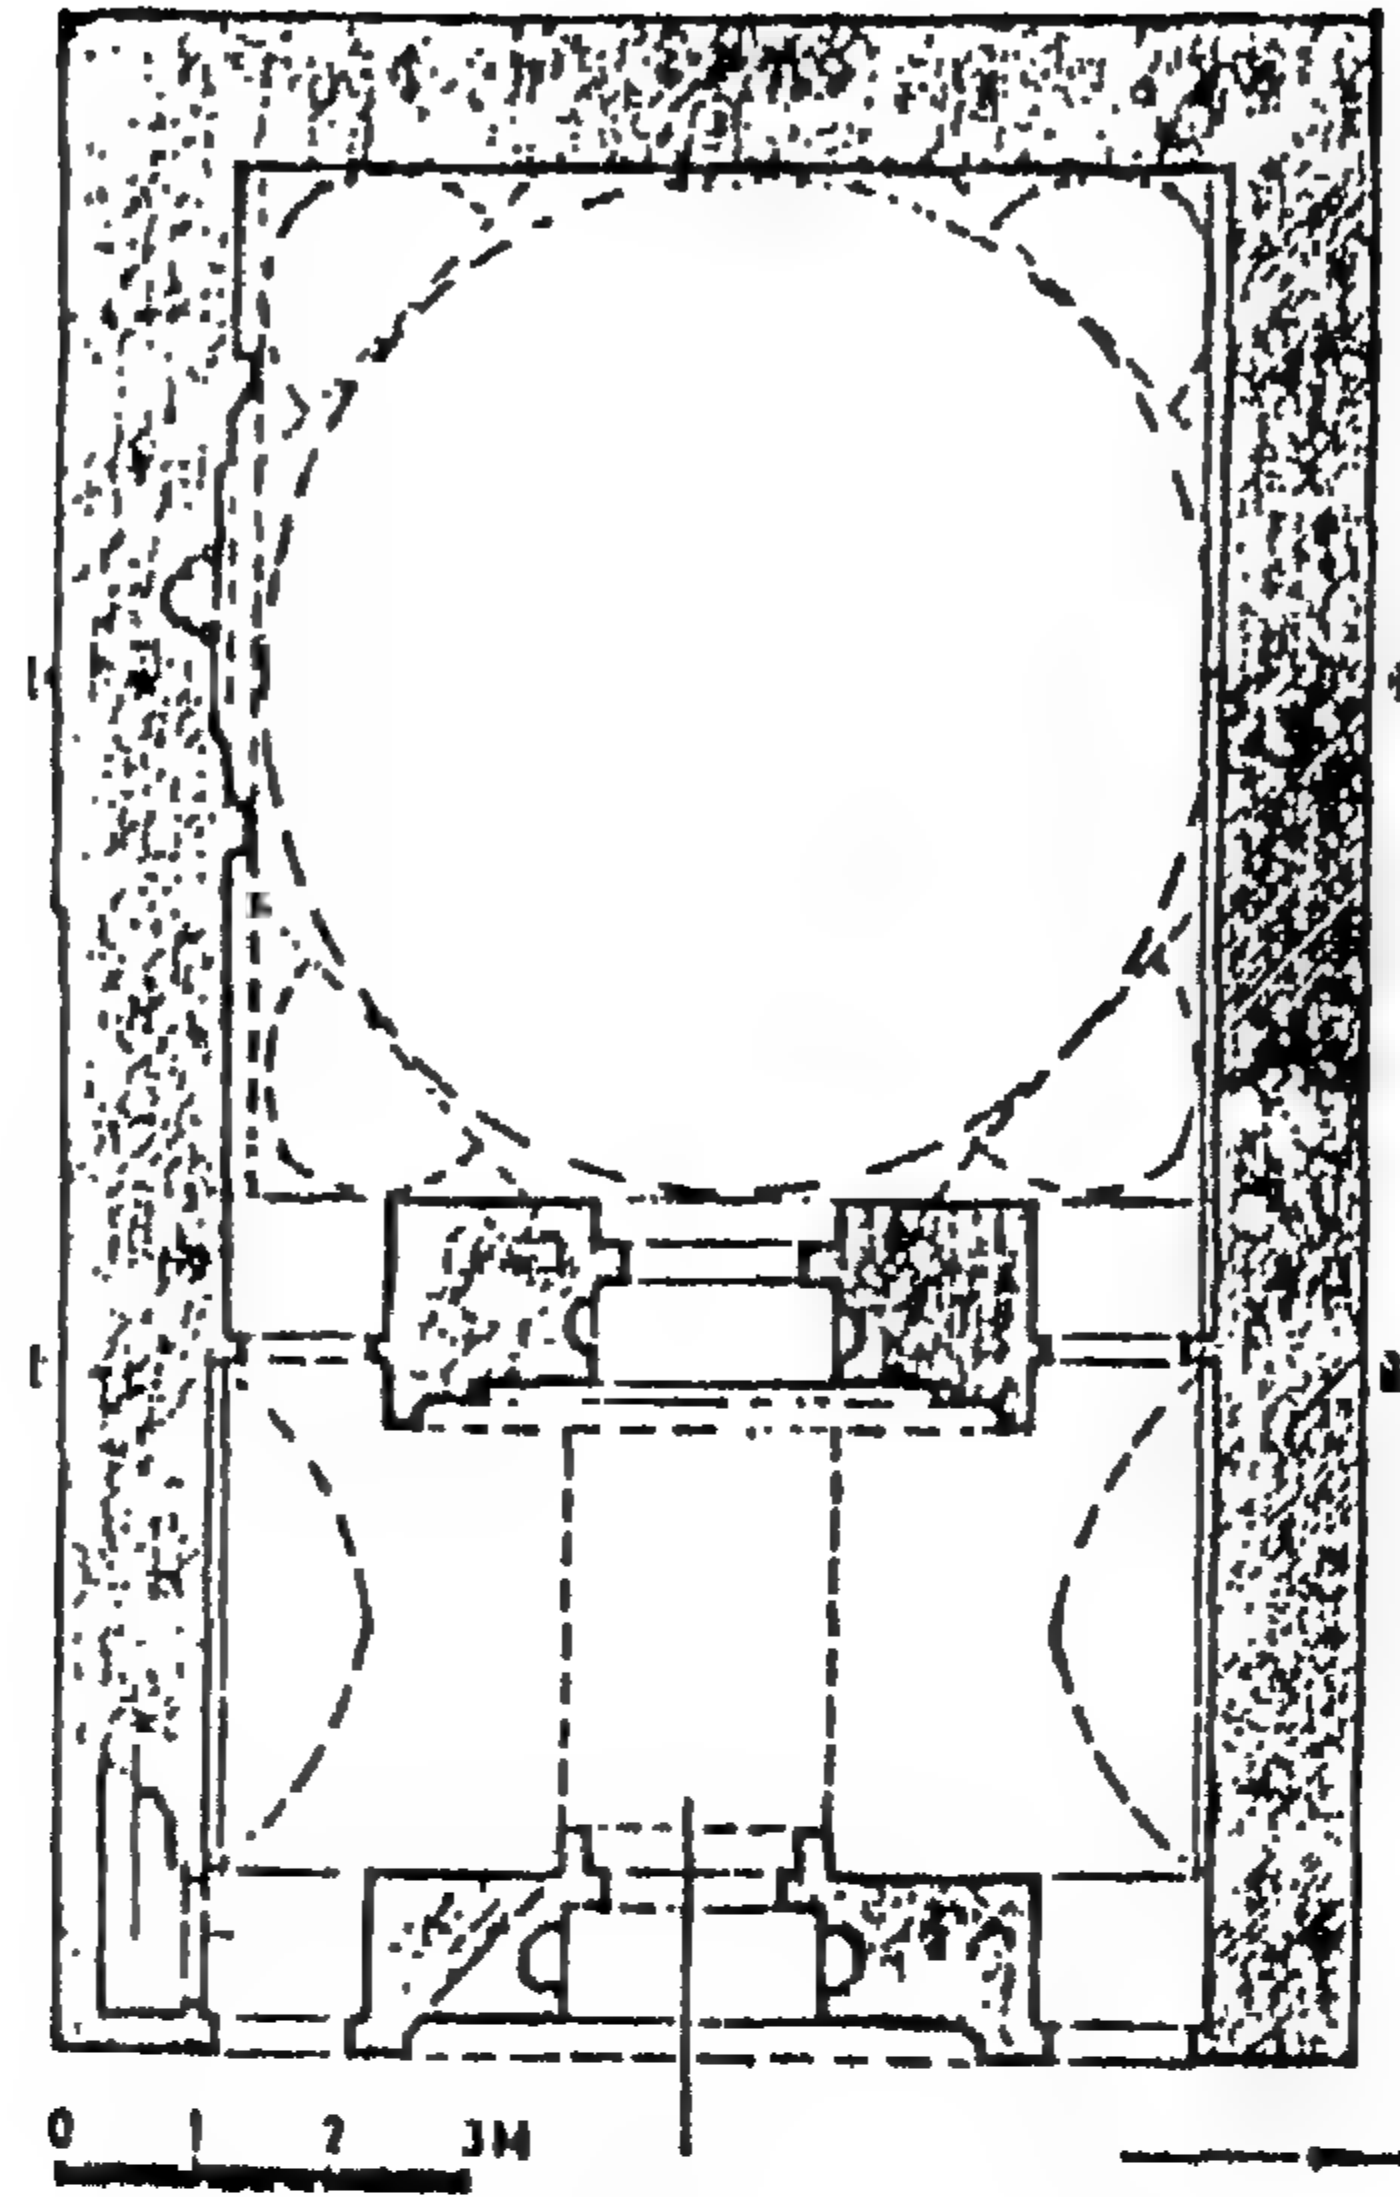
مسقط أفقي لجامع وقبة الشيخ خراسان في ازربيجان .
